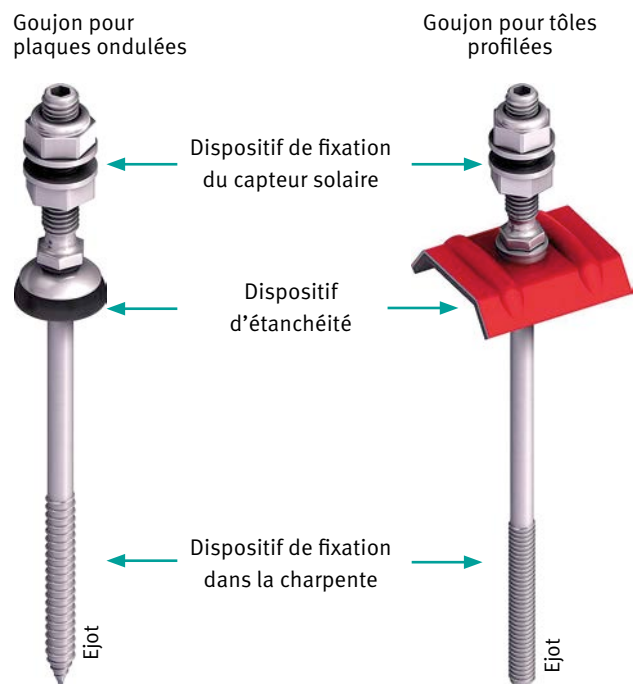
Exemples de goujons équipés d'une pièce d'étanchéité.
